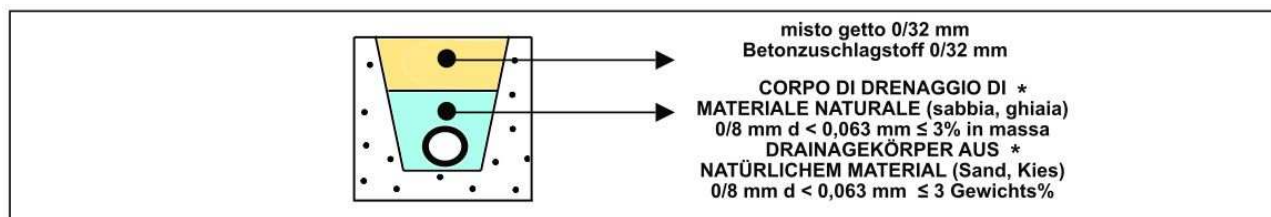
Auffüllungen und Drainagen (A Straßenbauwerke und B Gebäude):
